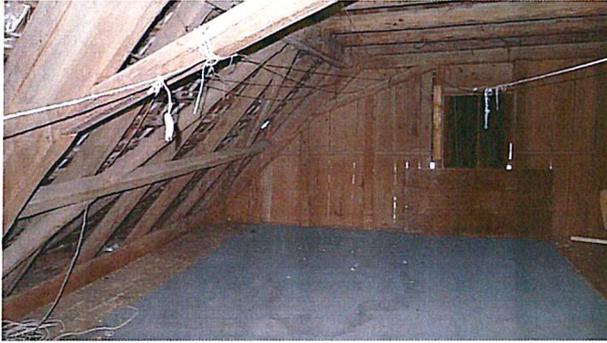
Dachgeschoss über dem Wohnteil. Blick nach Nordwesten an die Bretterwand gegen Ökonomieteil.
